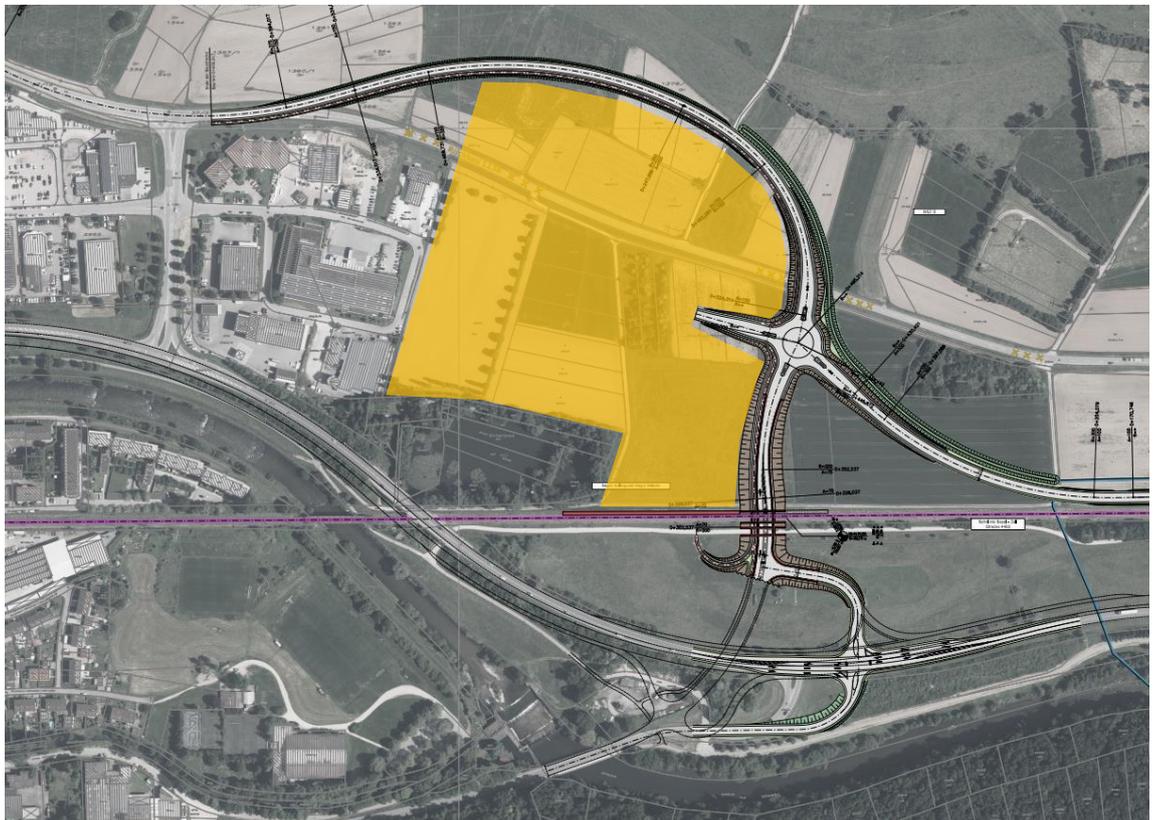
Lageplan (Rapp-Regioplan 12.2016) mit „Campus Zentralklinikum Lörrach“
